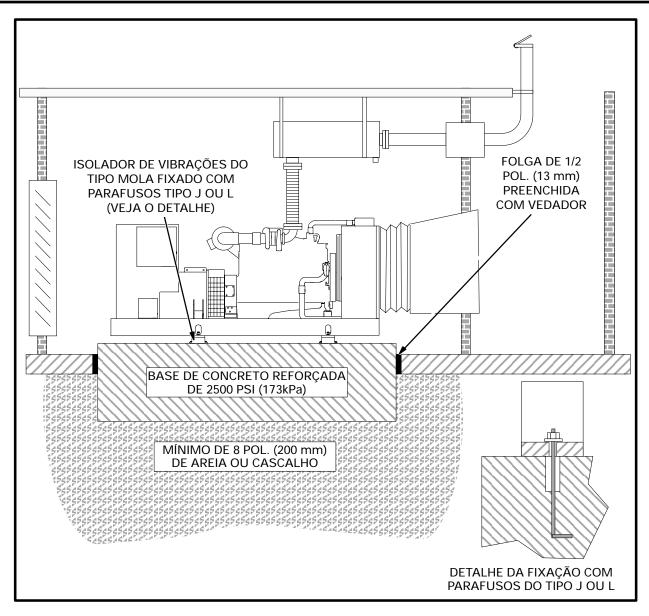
Fundação Típica de Isolamento de Vibrações
